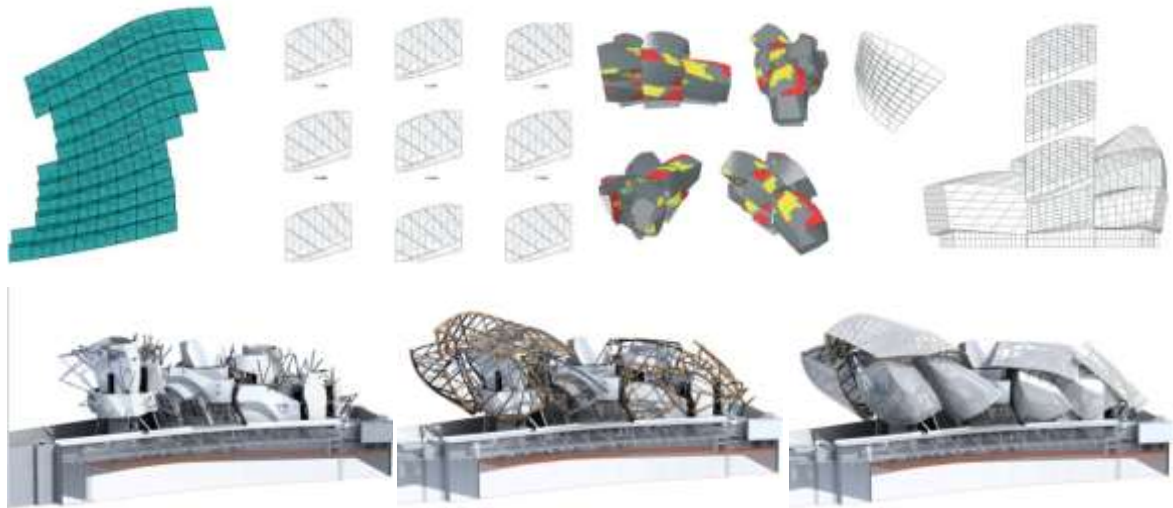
Utilisation du BIM à différentes échelles pour La Fondation Louis Vuitton, Paris, Architecte : Frank Gehry.
